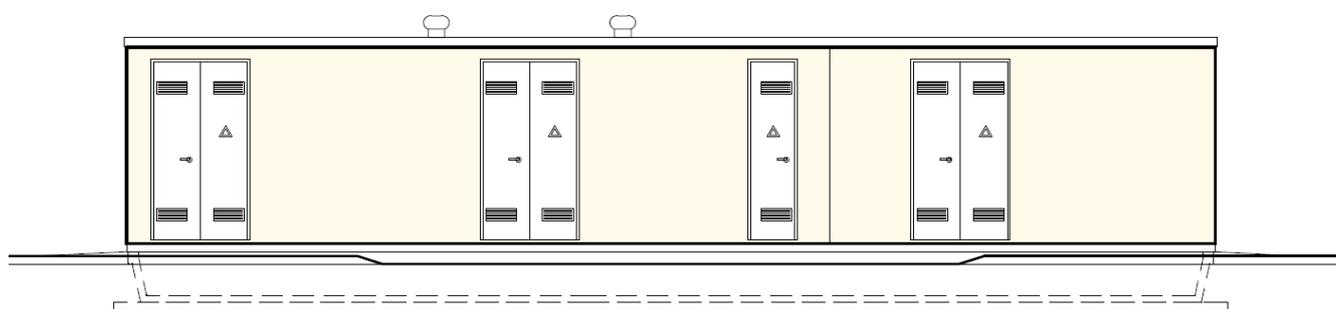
Prospetto frontale della cabina MT/BT (Via Arrio)
